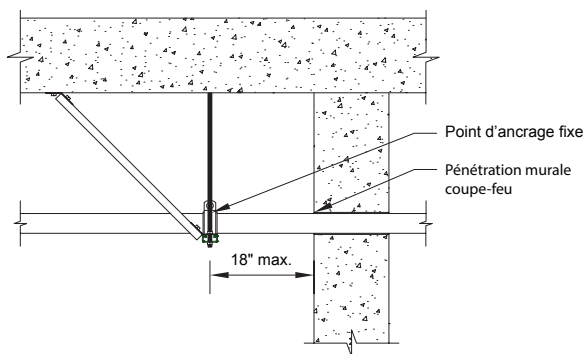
Point d'ancrage avec pénétration murale coupe-feu
